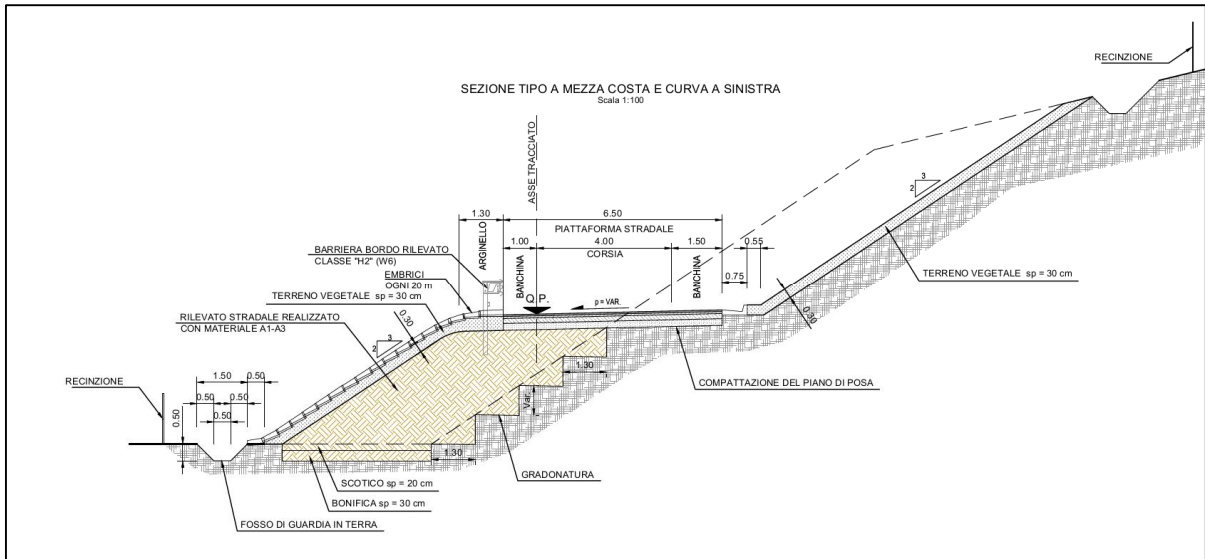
Sezione tipo rampa monodirezionale - sezione tipo in mezzacosta
